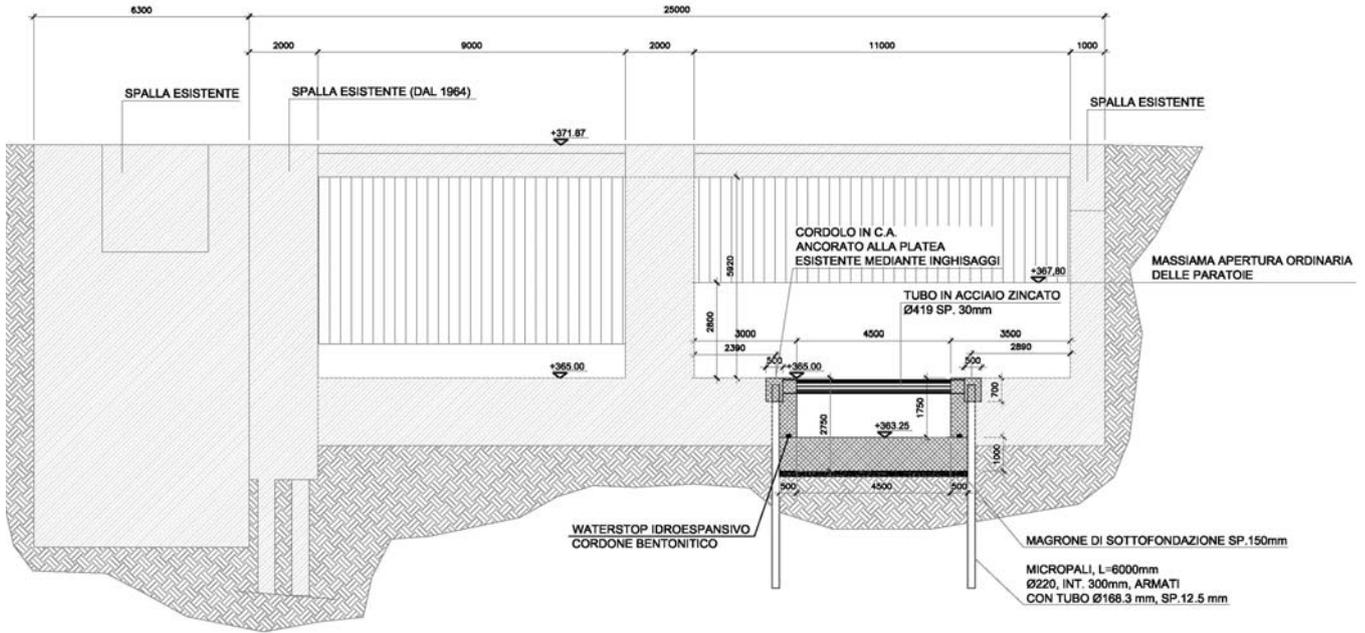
sezione trasversale dell'intervento alla traversa esistente
